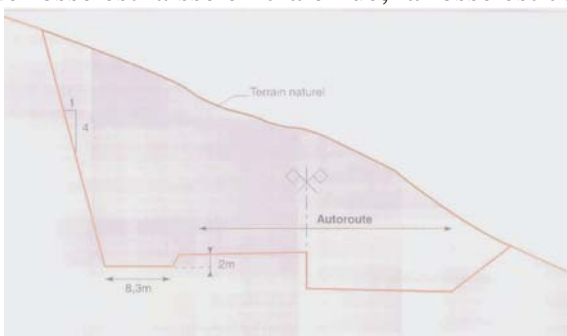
6 - Profil en travers d'un piège à blocs.
